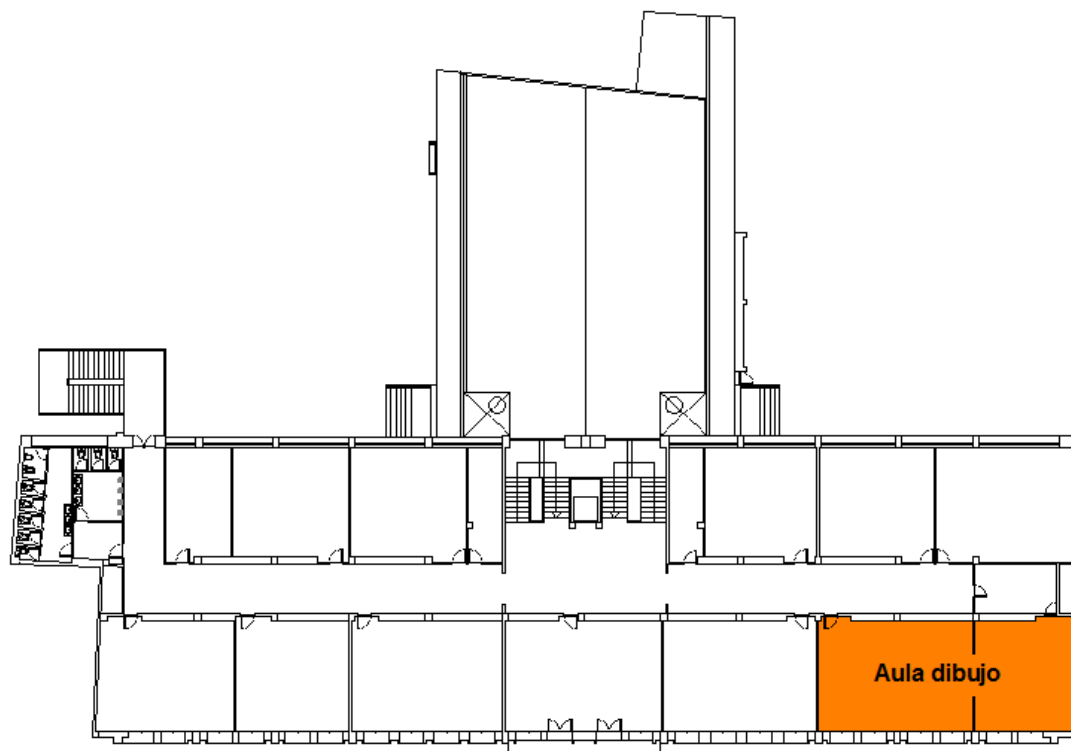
Locales de riesgo planta segunda. Fuente: Elaboración propia.
